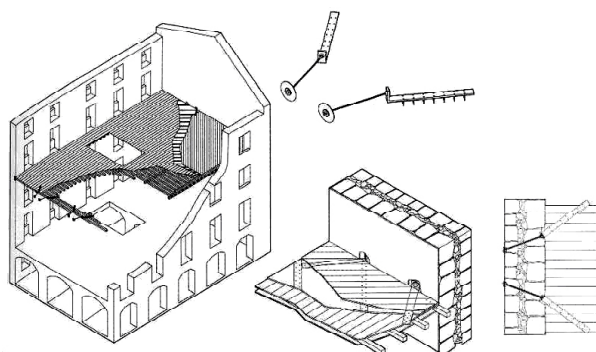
Pregagens entre paredes exteriores e os pavimentos.
